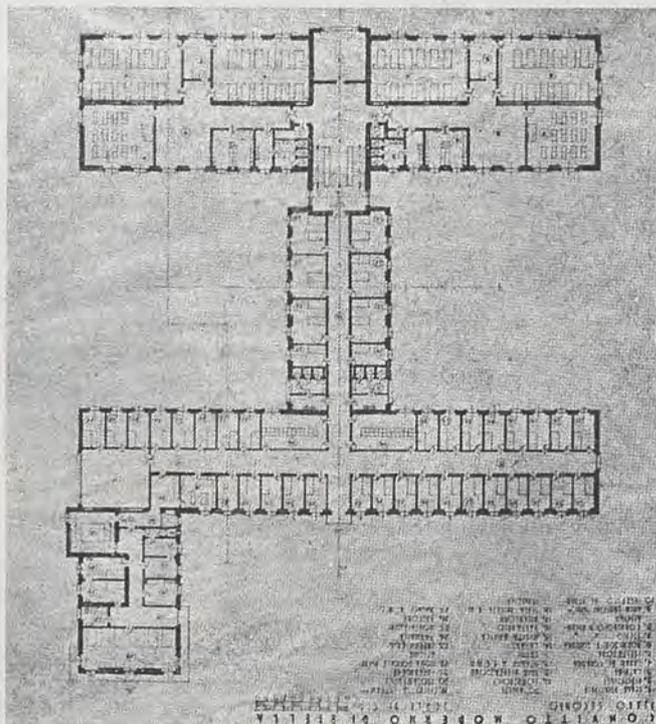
c - Convitto Biellese - I progetto: pianta del 2° piano.
